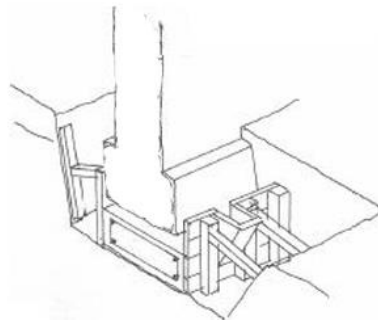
Colocação de cofragem e betonagem do recalço (11) .
